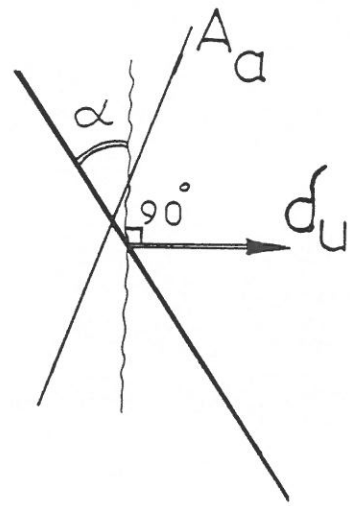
EQUILIBRE DU VOILE SUR UN PLAN DIAGONAL
